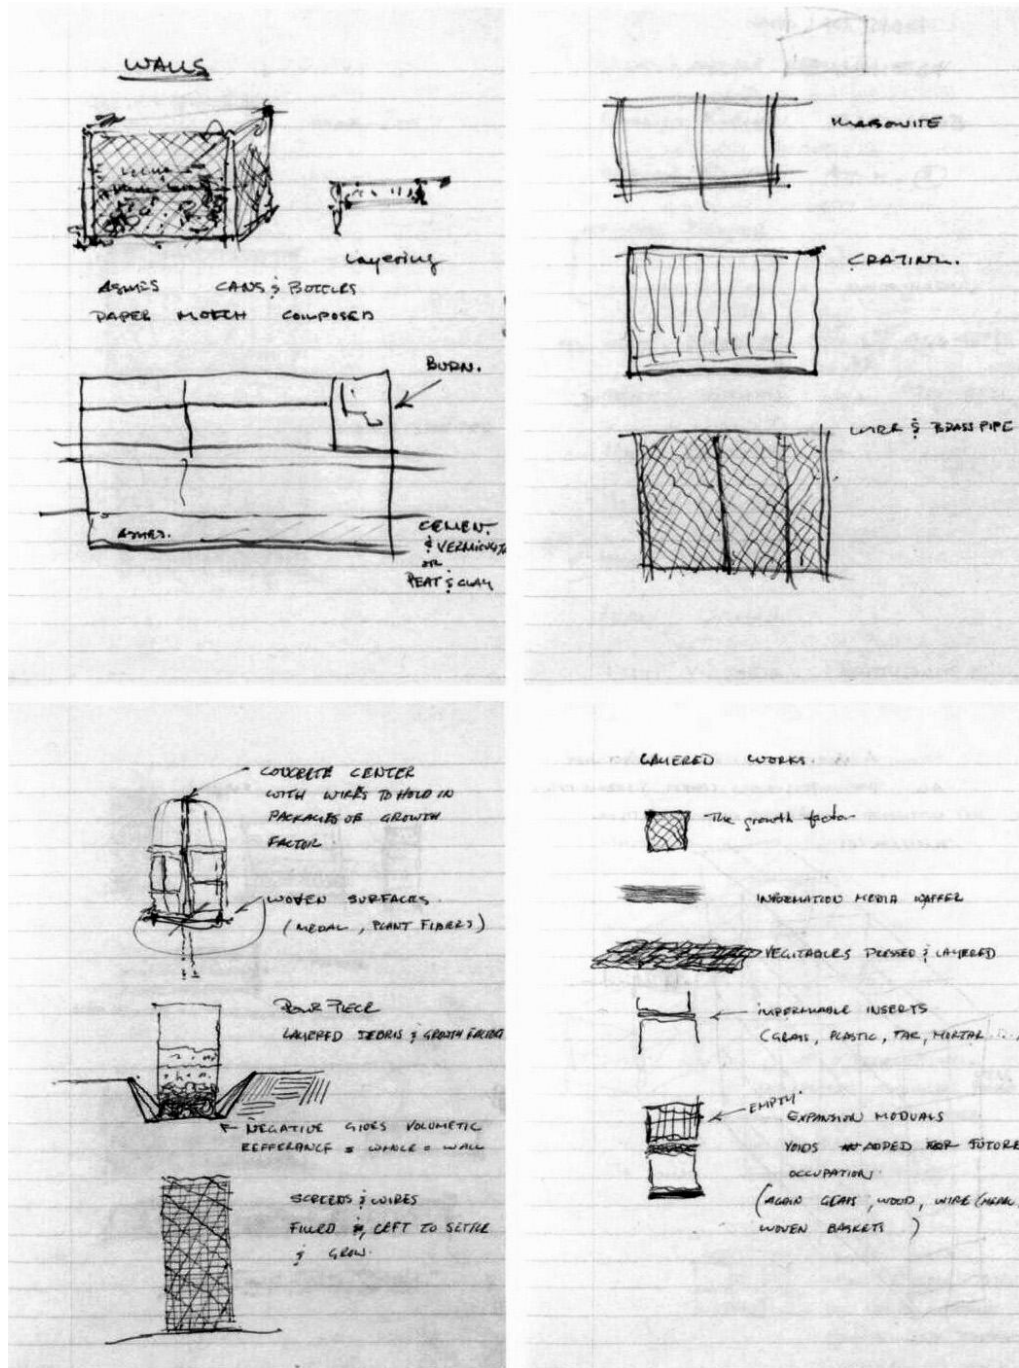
Walls, c. 1970, caderno. Projeto para realização de Garbage Wall.
